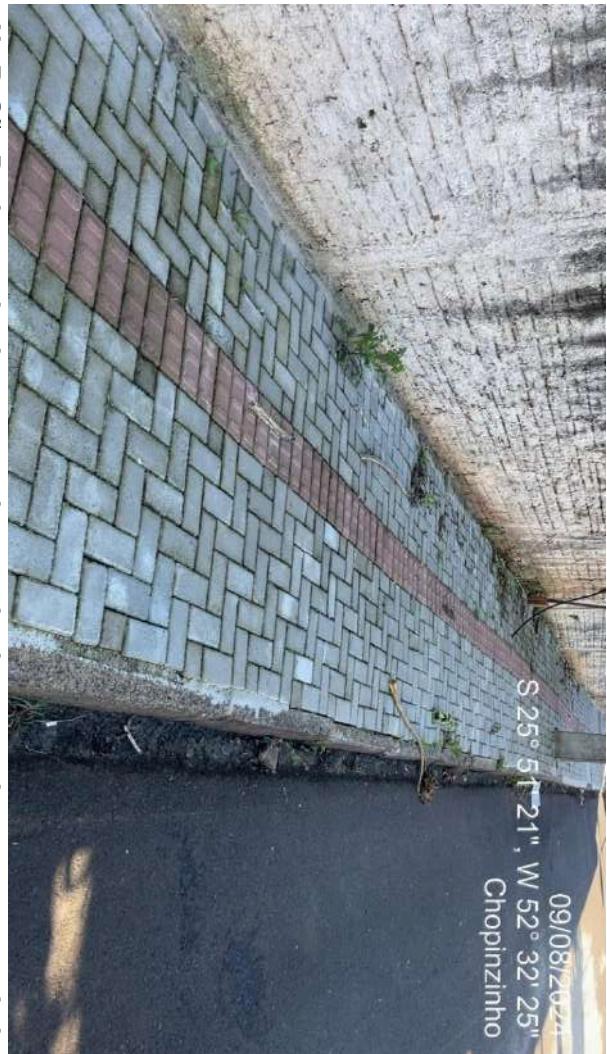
Na R. São Paulo as calçadas executadas em piso intertravado apresentaram baixa qualificação executiva;
